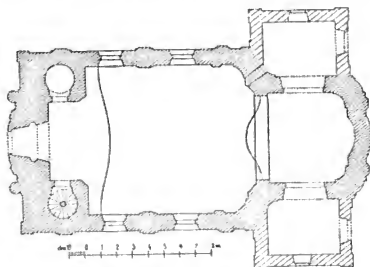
Řešihlavy. Grundriss der Kirche.
